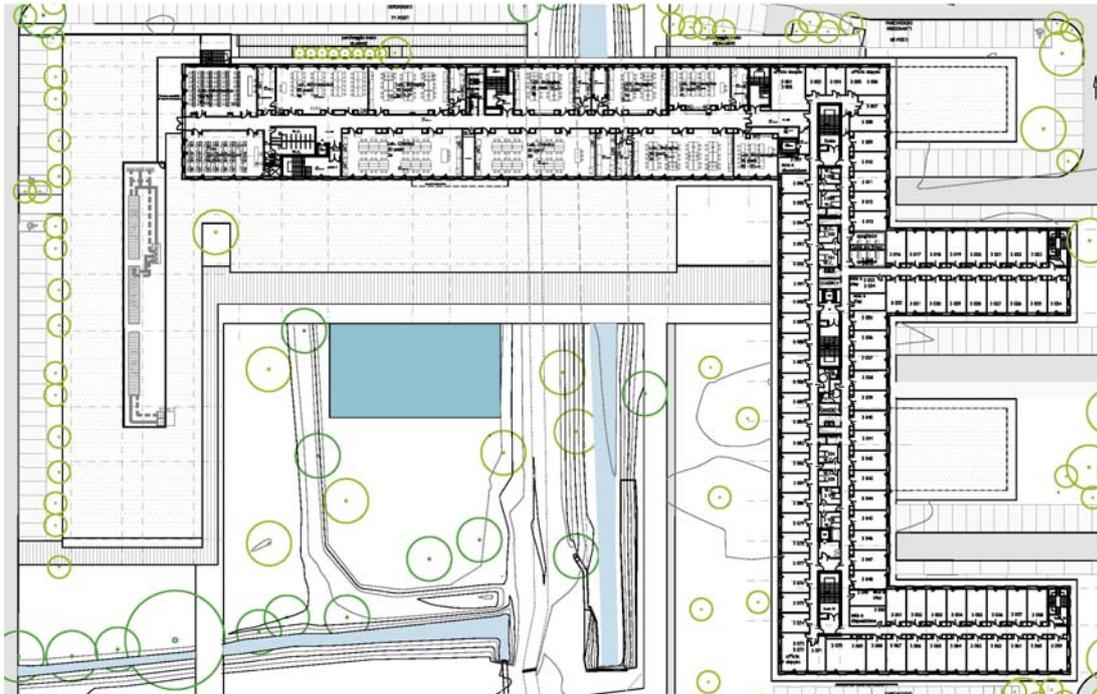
Pianta piano terzo Lotto 1-2 e identificazione funzionale
